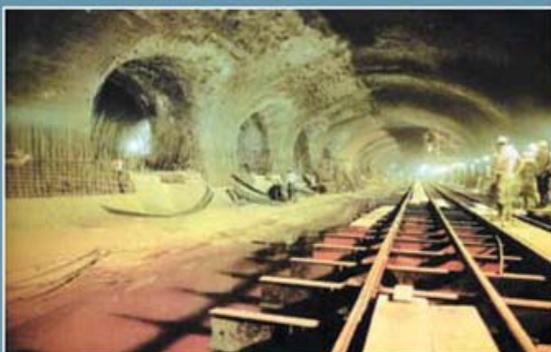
Vista do interior da estação Consolação durante a escavação (CBT, 2006)
